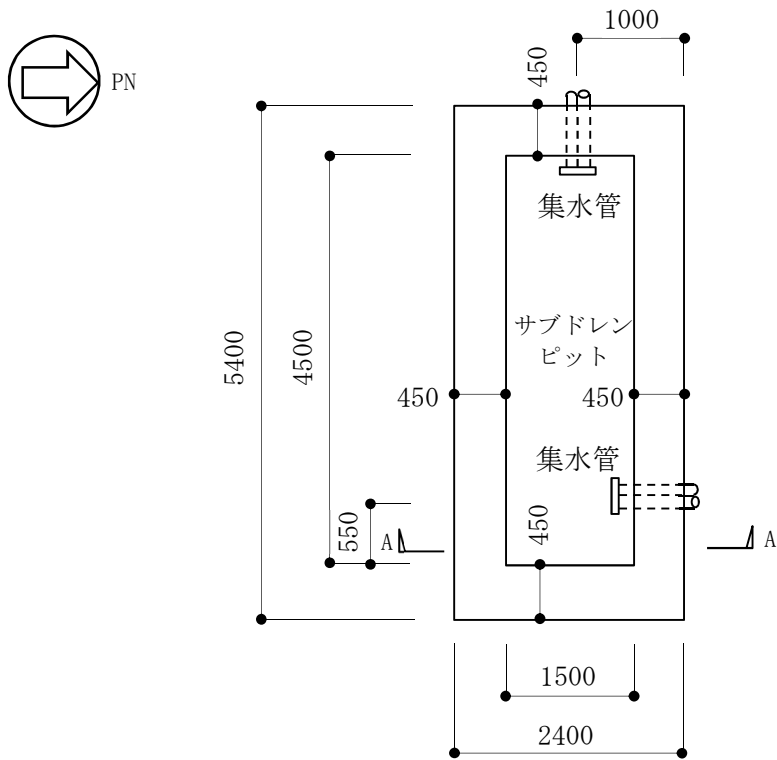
原子炉建屋サブドレンピットの概略平面図 (T.M.S.L. -15.20m) (単位 : mm)
